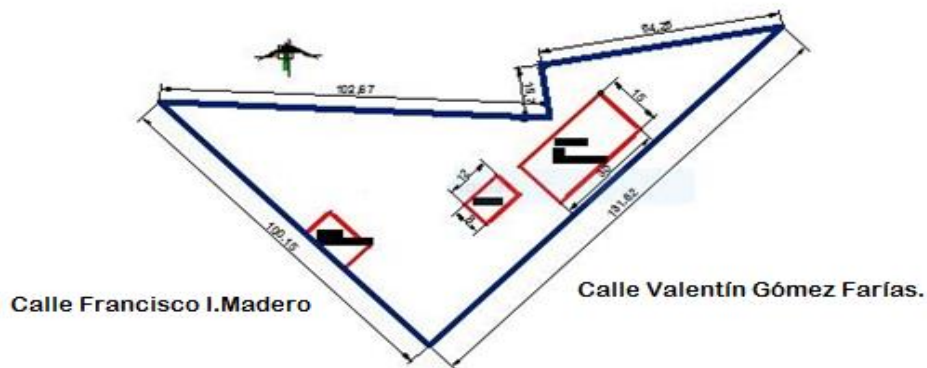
Levantamiento arquitectónico del estado actual del predio.
